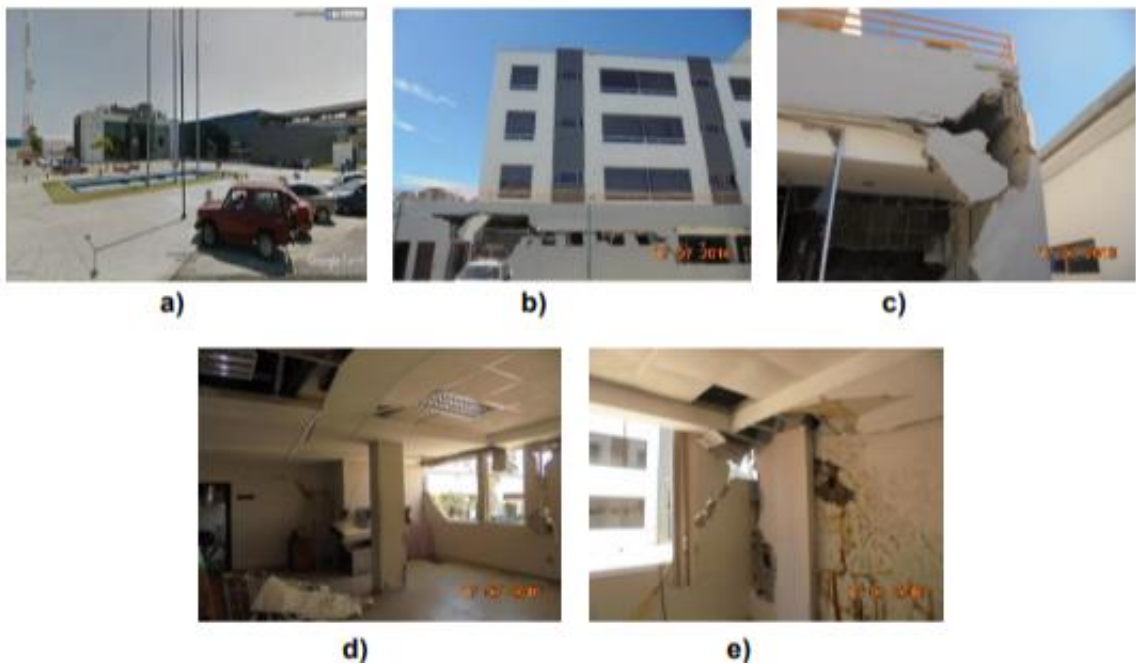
a) Vista general. b) Mampostería con daño extensivo en fachada principal. c) Mampostería con daño extensivo en fachada posterior. d) Columnas de acero rellenas de hormigón. e) Falta de elementos confinantes.
